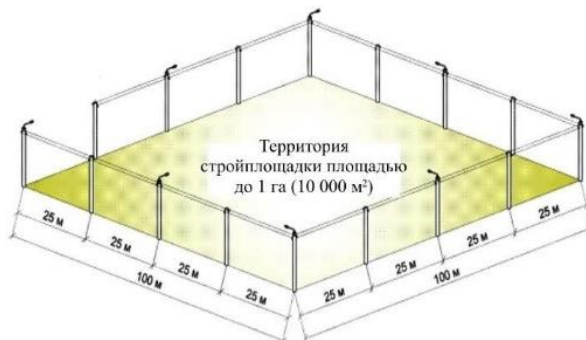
Схема освещения строительной площадки при помощи осветительных мачт
